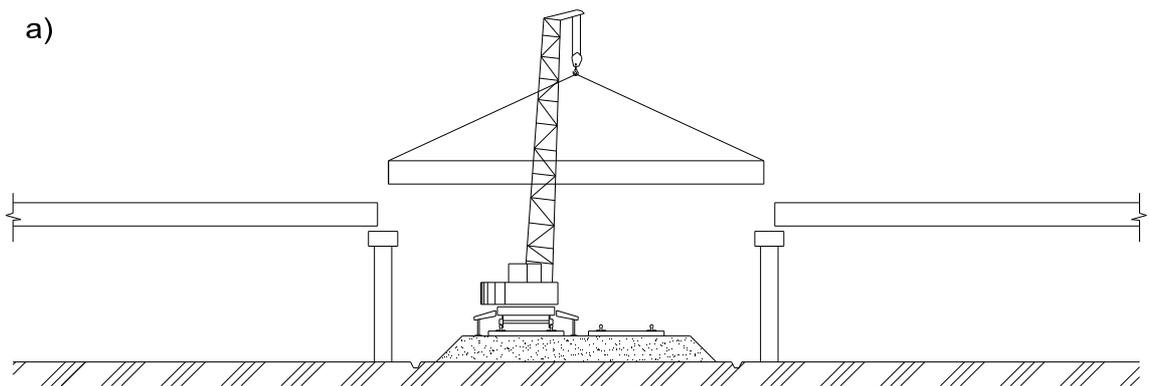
Варианты схем монтажа разрезных балочных пролетных строений:
